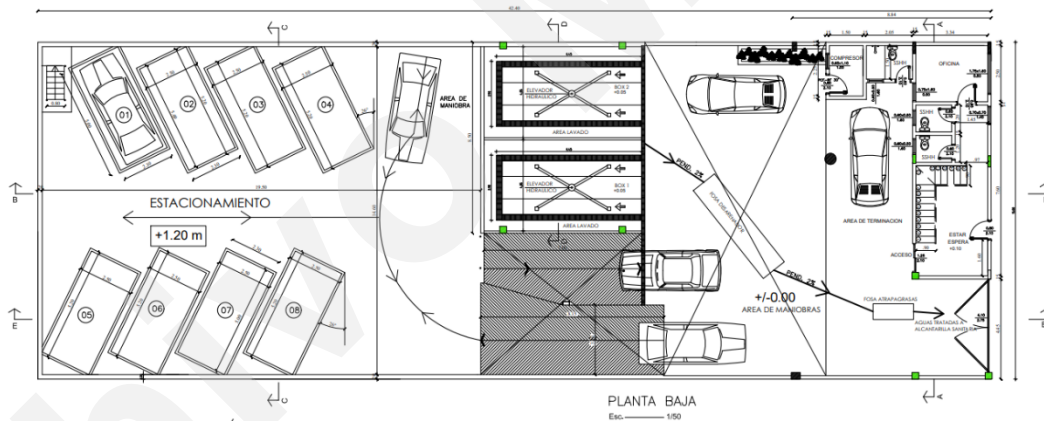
Plano constructivo del área de lavadero de vehículos en planta baja. Fuente: Plano Municipal elaborado por Ing. Jorge Cristaldo PAT 19.399
